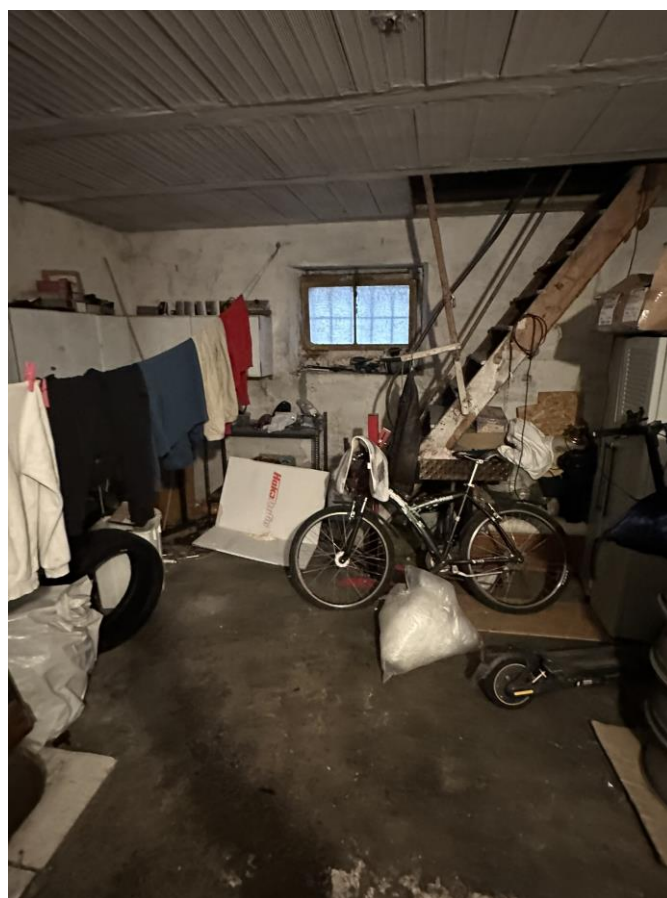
Rustico – Scala accesso soffitta piano primo – P.T.
